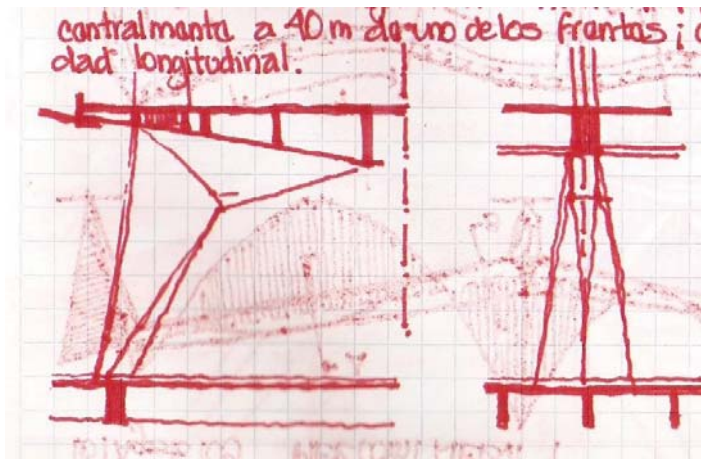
Croquis de los detalles del apoyo en vista lateral y frontal.
